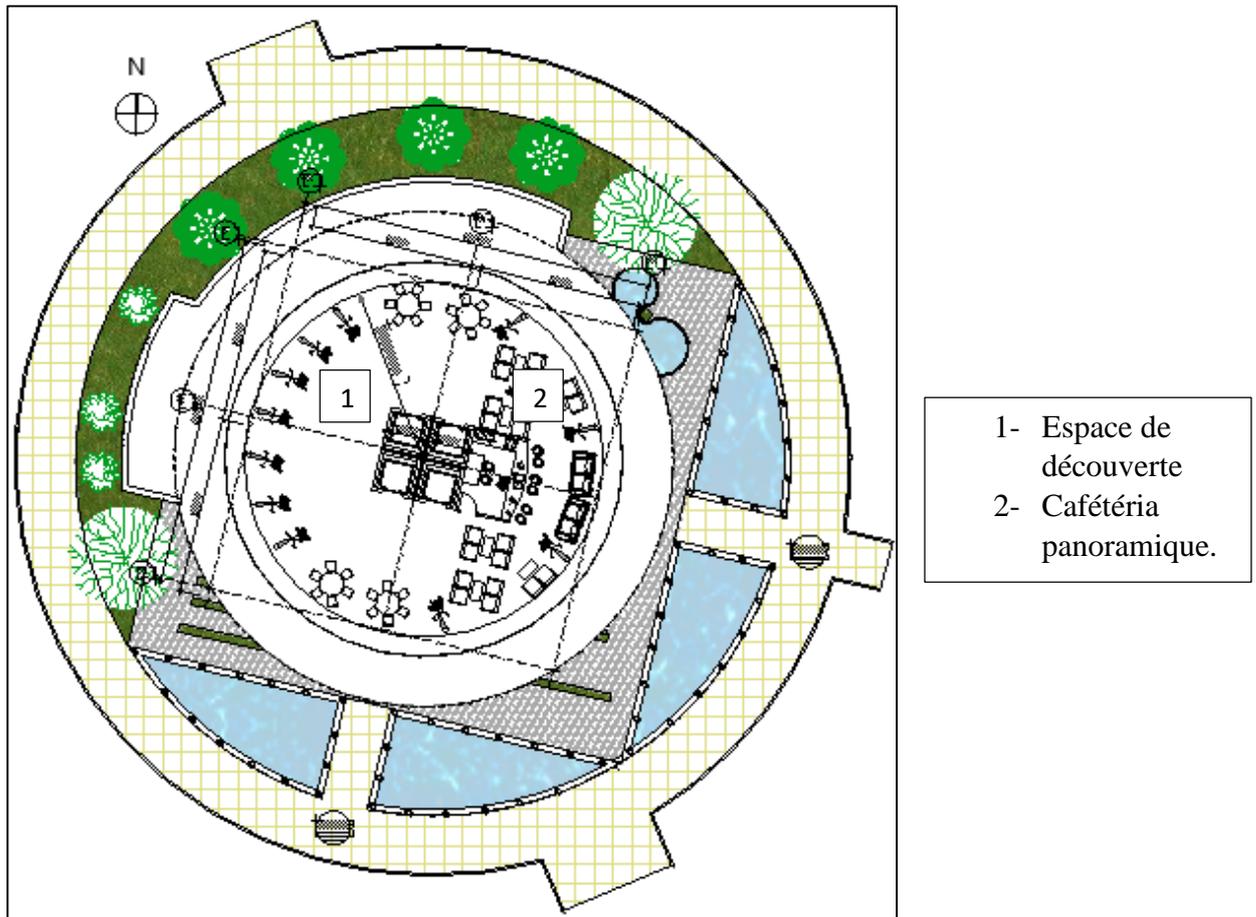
Plan de la tour 2<sup>ème</sup> étage (source : auteur).
